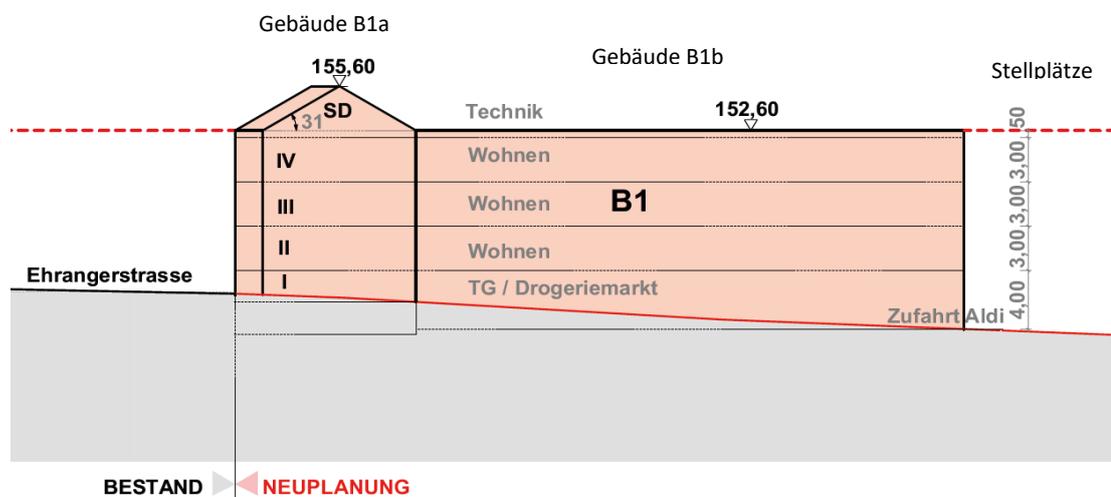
Schnitt durch Gebäude B1a (links) und Gebäude B1b (rechts)
